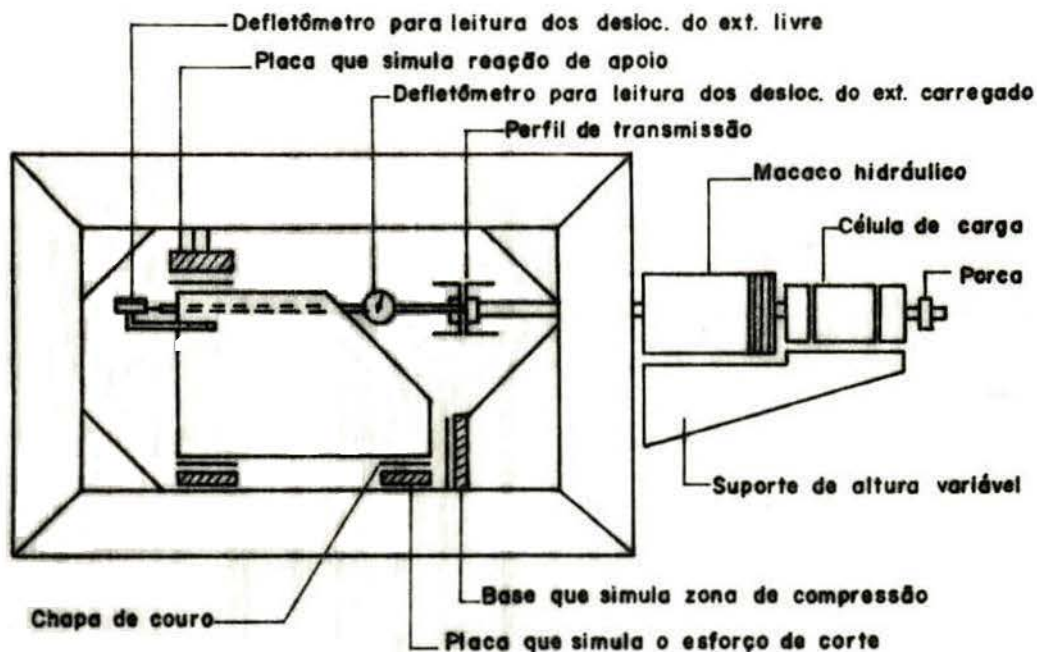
Detalhes dos dispositivos de ensaio.
